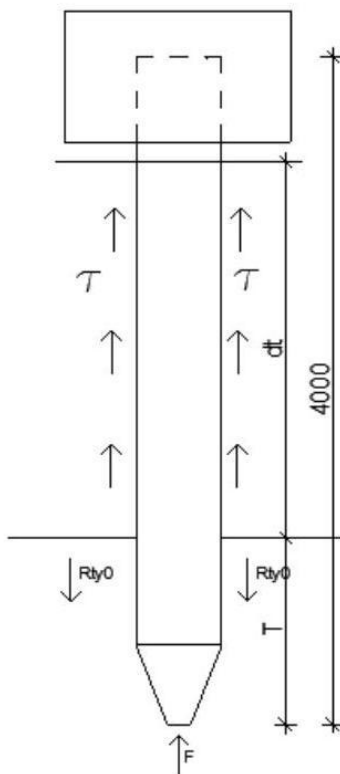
Розрахункова схема пальового фундаменту
